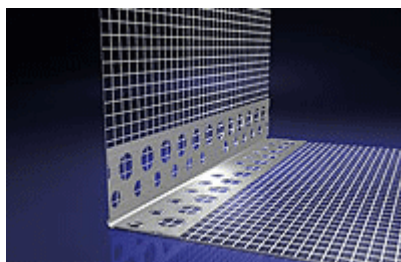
Vyztužení rohů – profil s integrovanou síťovinou (D3)
